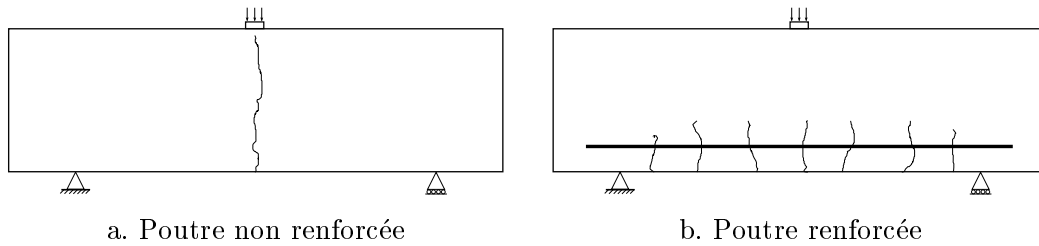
Illustration du procédé de fissuration dans une poutre en béton sur un essai de flexion trois points.
